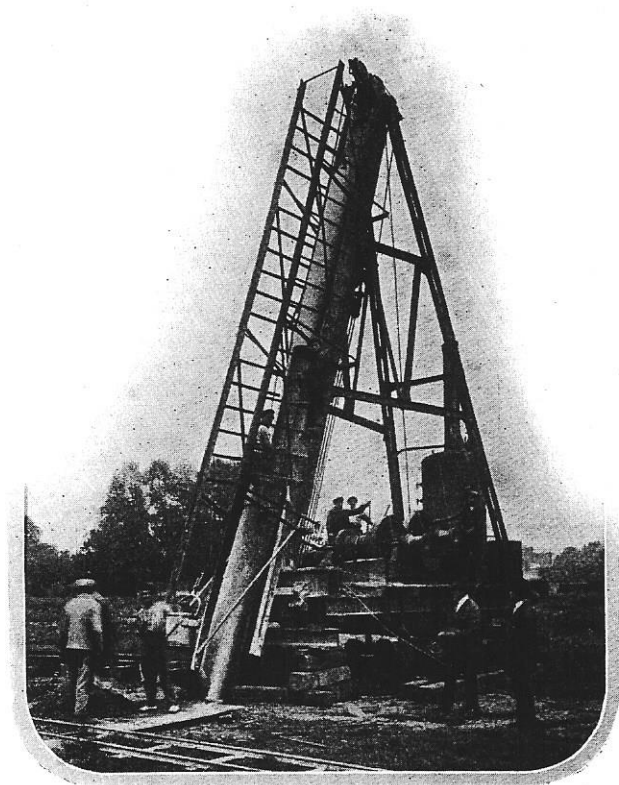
Vue de la machine Franki, équipée pour le battage des pieux inclinés.
